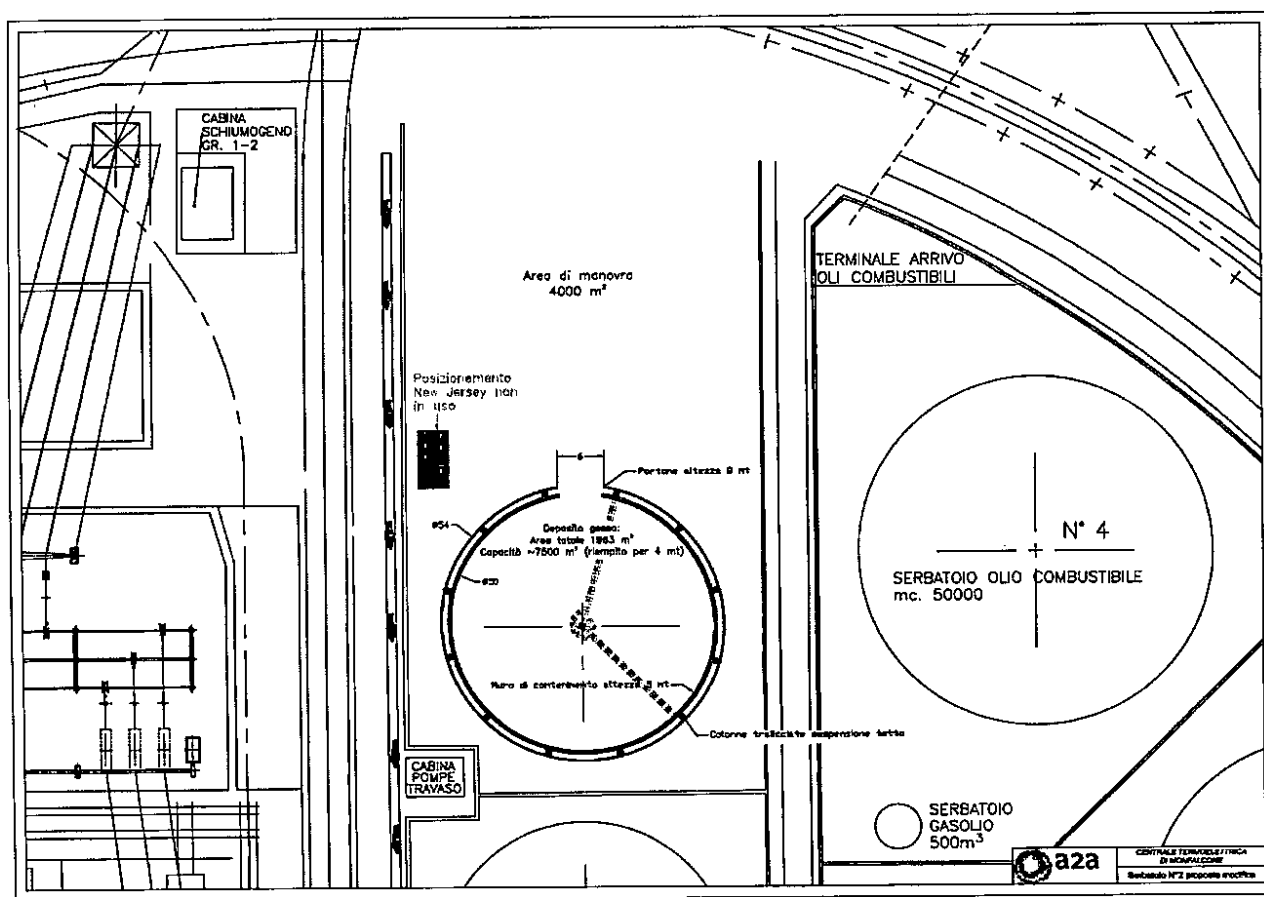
Planimetria 2D del serbatoio num. 2 con volumi di accumulo
